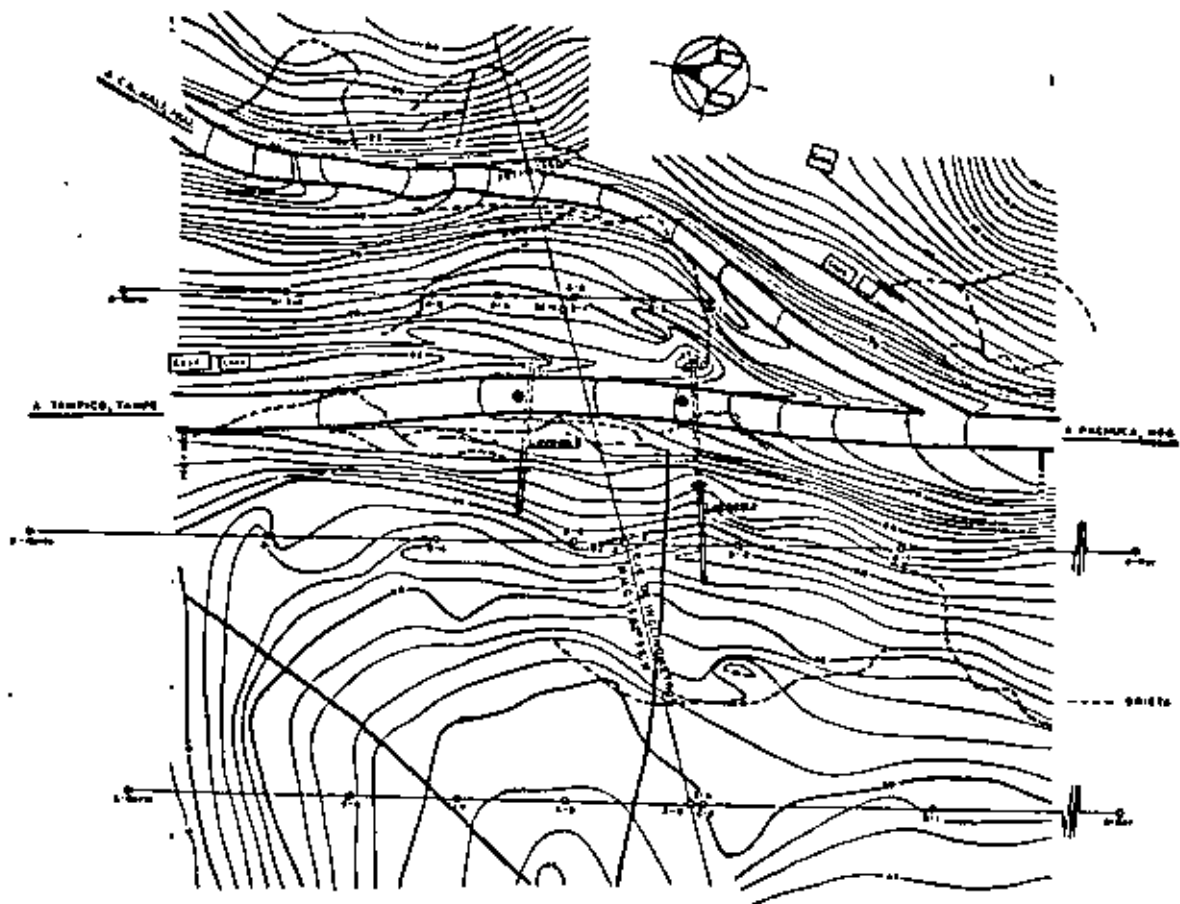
Planta topográfica de la zona de deslizamiento.
